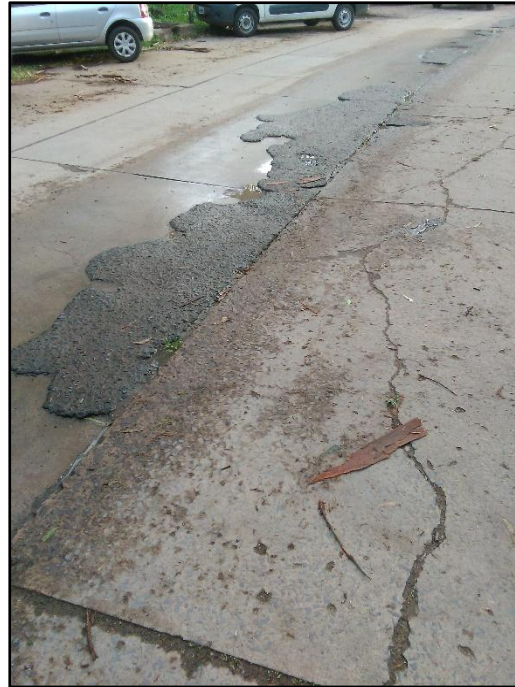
fisuras en el pavimento en los tramos 1, 3, 7, 9.
